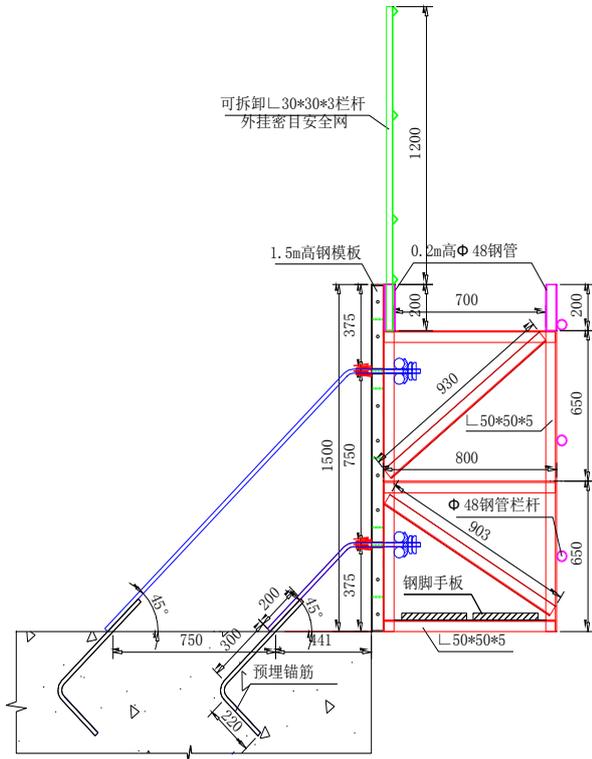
模板钢架施工平台布置侧立面图 (单位: mm)
